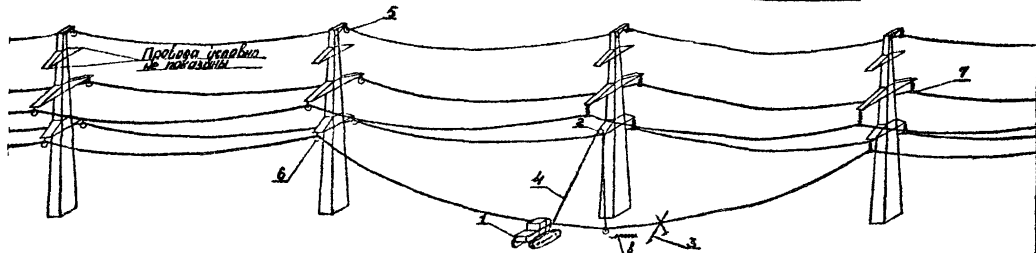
Узел А. Перекладка провода верхней траверсы с опусканием его на среднюю траверсу опоры
